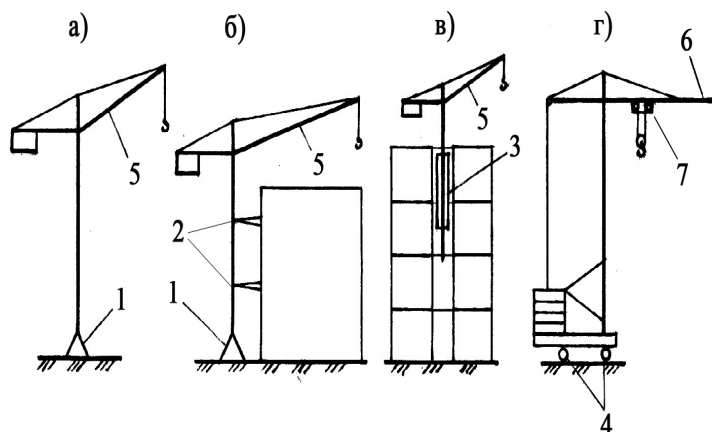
Схемы установки кранов: 1 – фундамент или звено подкрановых путей; 2 – крепление крана к возводимому зданию; 3 – подвижная обойма с четырьмя гидроцилиндрами для обоюдного перемещения ее и башни; 4 – рельсо-колесное ходовое оборудование; 5 – подъемные стрелы, установленные на неповоротные башни, 6 – балочная стрела, укрепленная на поворотной башне; 7 – грузовая тележка
